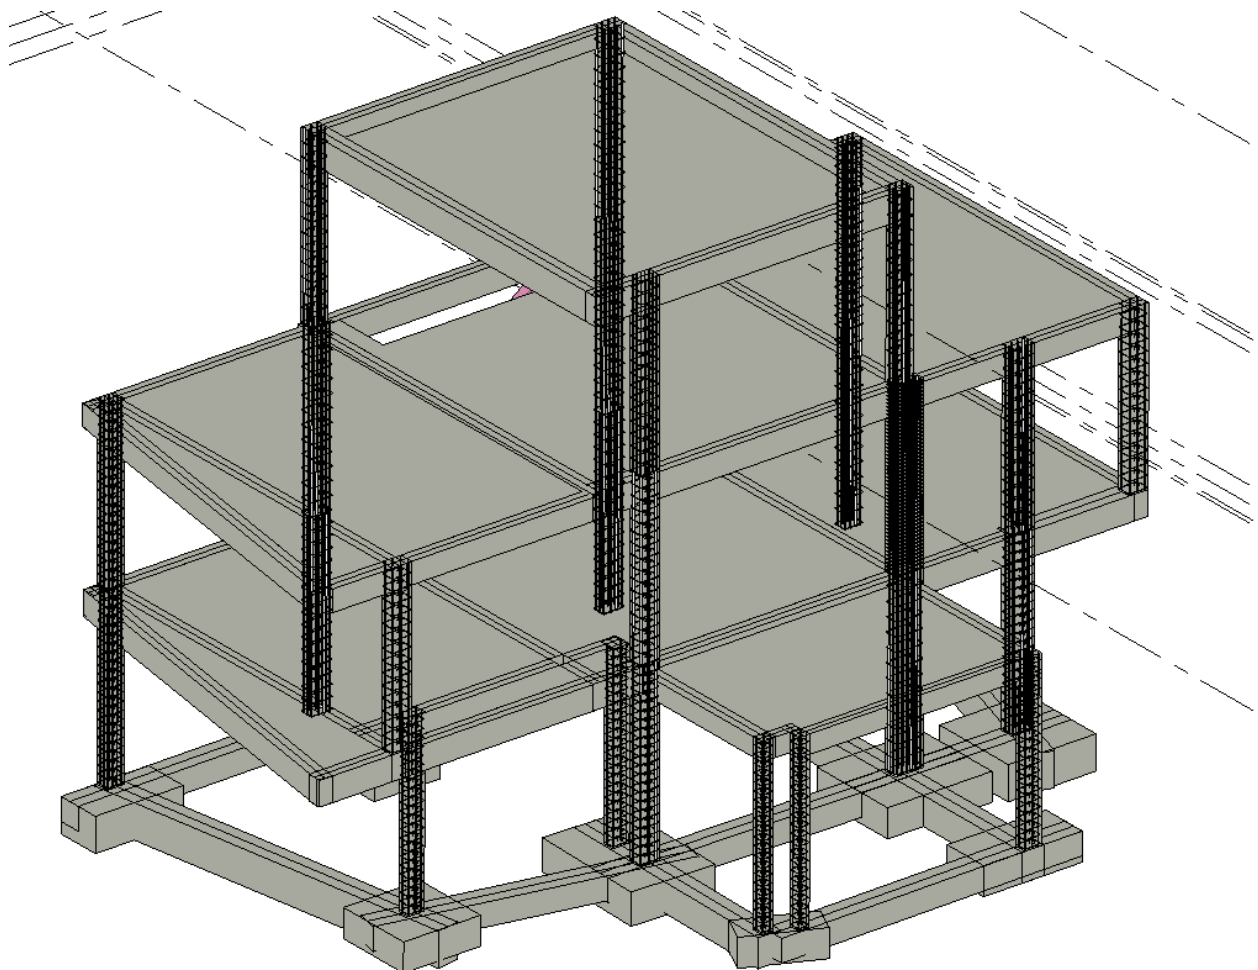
Representação tridimensional das Armaduras dos Pilares
